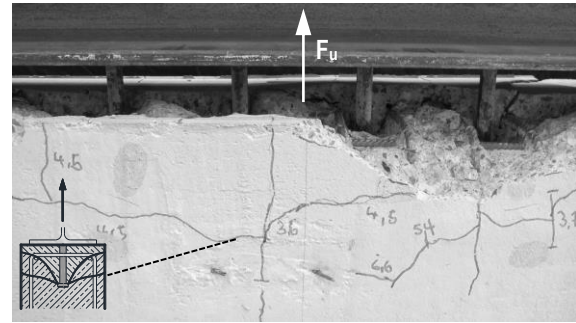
Betonausbruch zwischen der Bewehrung im Versuch R-02
